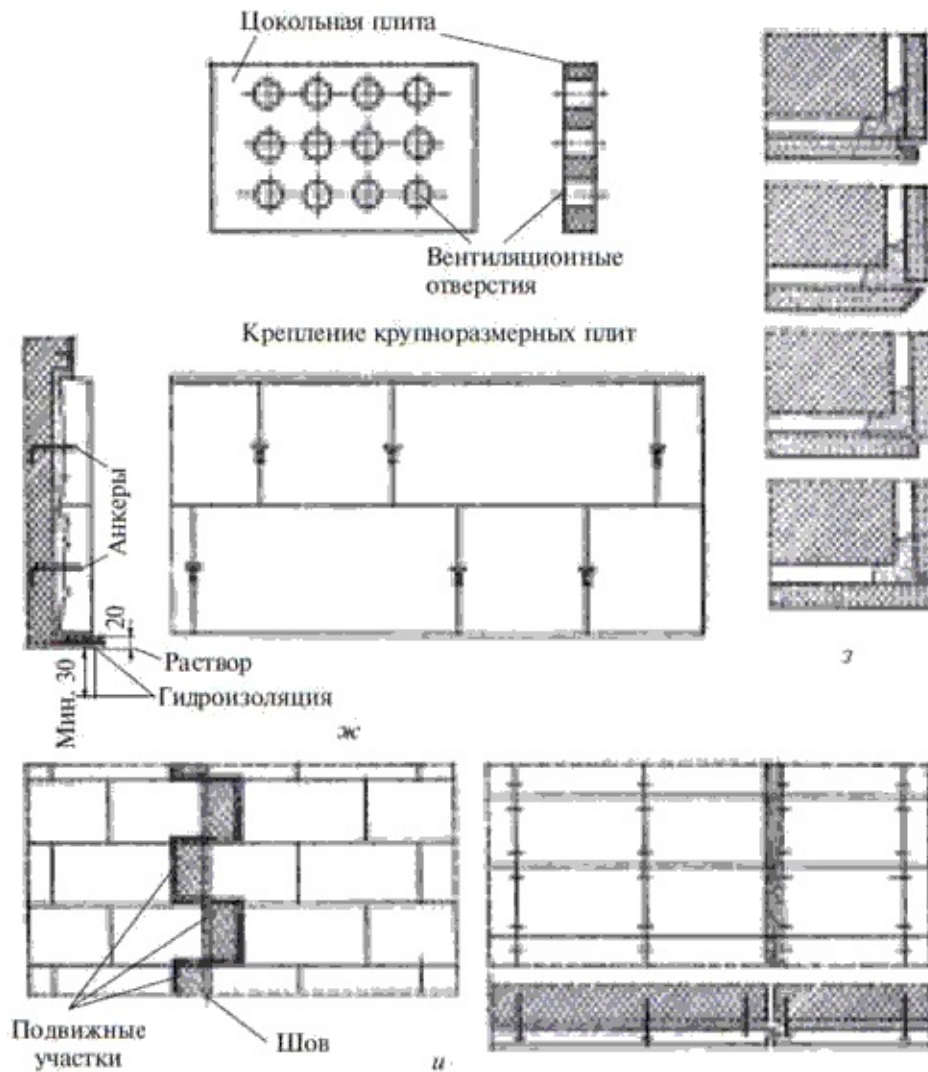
(продолжение). Облицовка пилеными плитами (размеры в см): ж – устройство анкеров; з – расширительный шов; и – конструктивное решение
